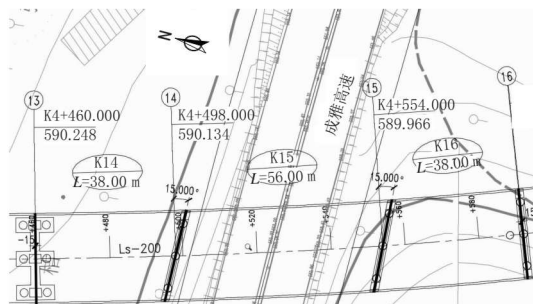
板栗坡大桥上跨成雅高速平面布置图(单位:m)
